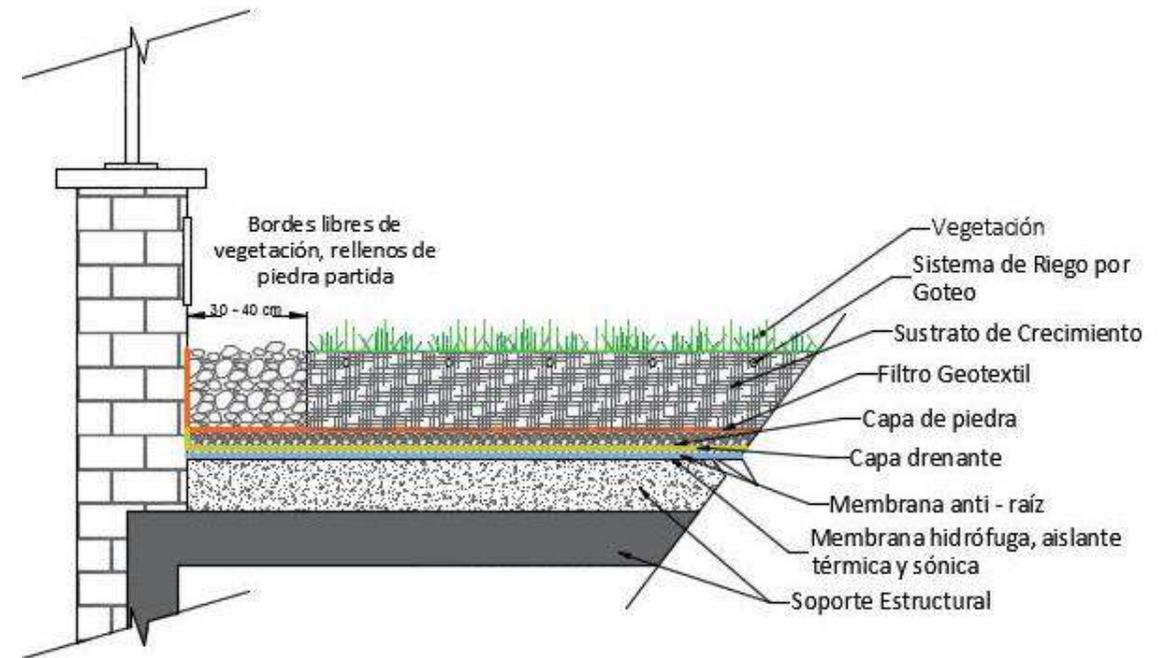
DETALLE CONSTRUCTIVO DE UNA CUBIERTA VERDE.
